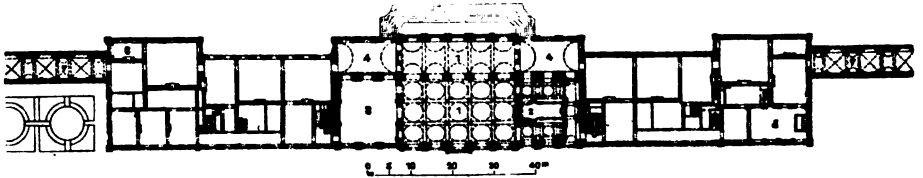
Schleißheim. Grundriß des Erdgeschosses.
